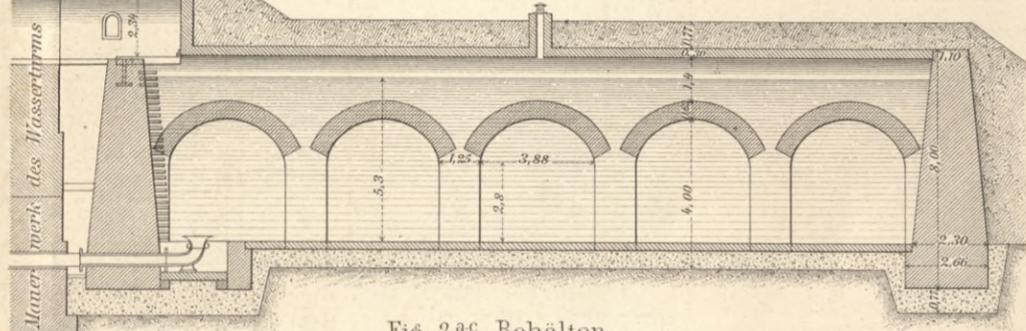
<sup>a c</sup> Behälter zu Wiesbaden (Stampfbeton).
